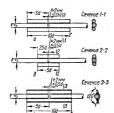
Стык стержней периодического профиля, выполненный дуговой сваркой с иакладками (для гладких стержней вместо 2,5d, 5d, 10d принимается 2d, 4d и 8d).
